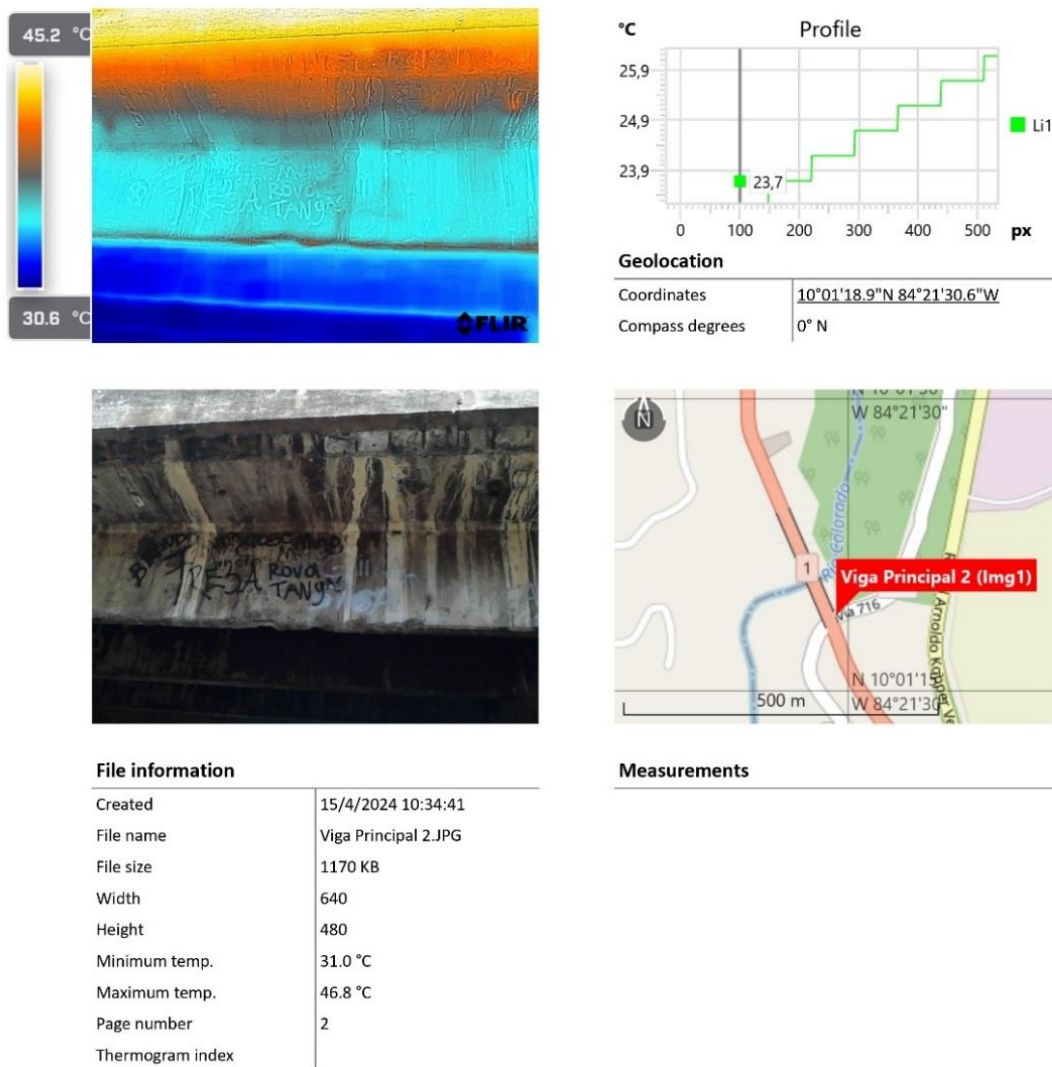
13 Reporte térmico del descascaramiento de vigas en la sección No. 1
